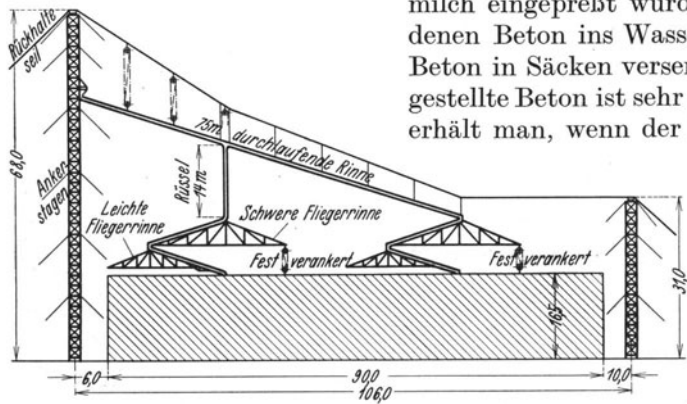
Betongießanlage. (Nach H. Gaye: Bautechnik 1931, S. 162.)
